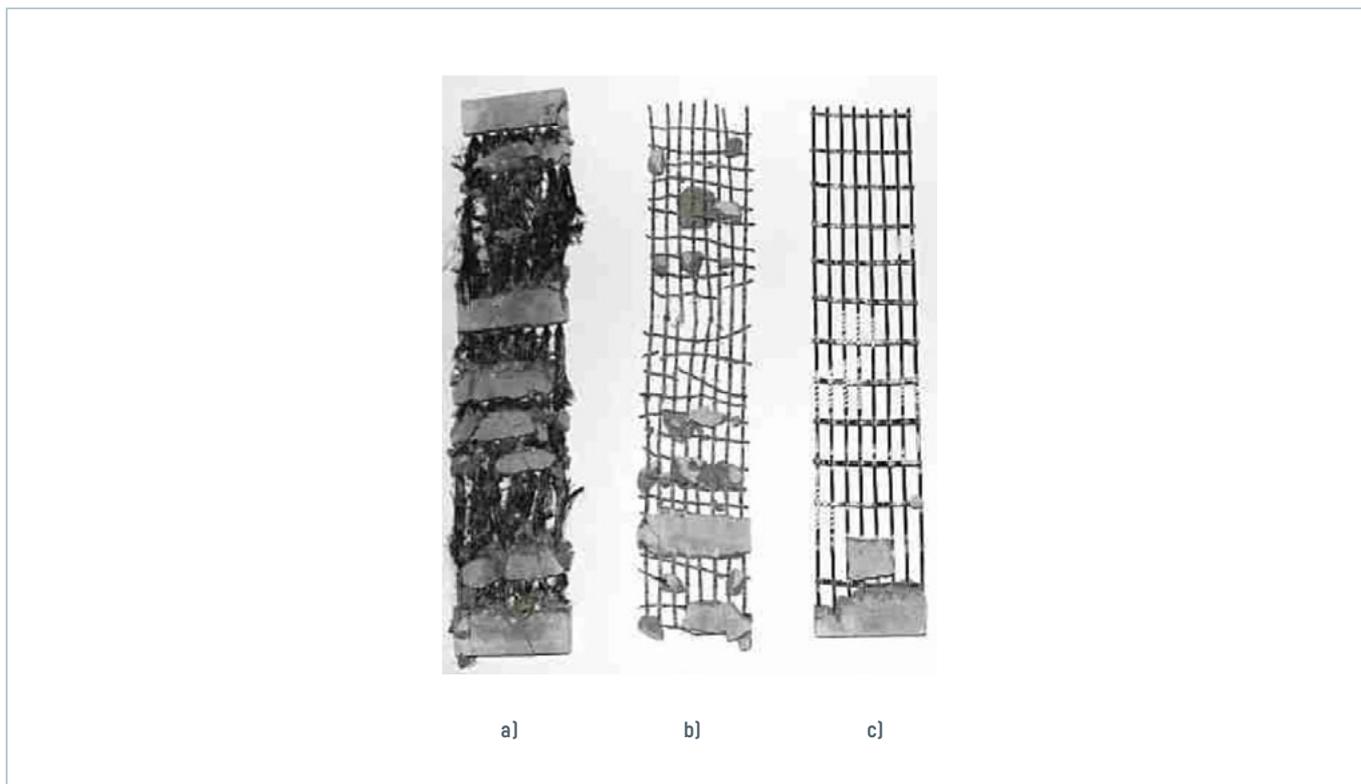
Ergebnis der Zerkleinerung von Textilbeton mit beschichteter Carbonbewehrung im Backenbrecher [93] Bewehrung beschichtet mit a) Kaliumsilikat b) Styrol-Butadien-Kautschuk, c) Epoxidharz
